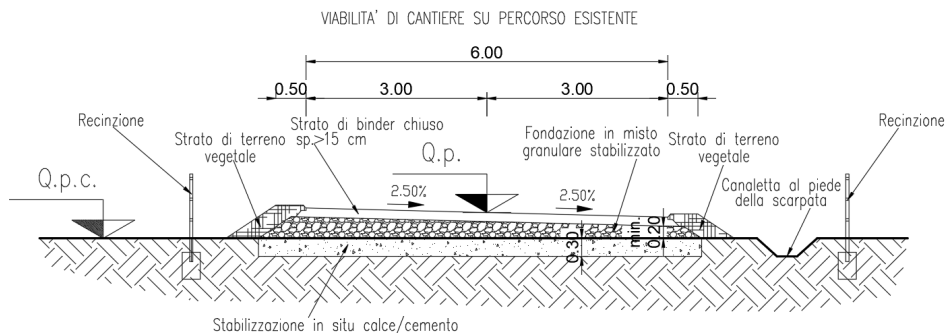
Sezione tipo piste di cantiere su percorso esistente
